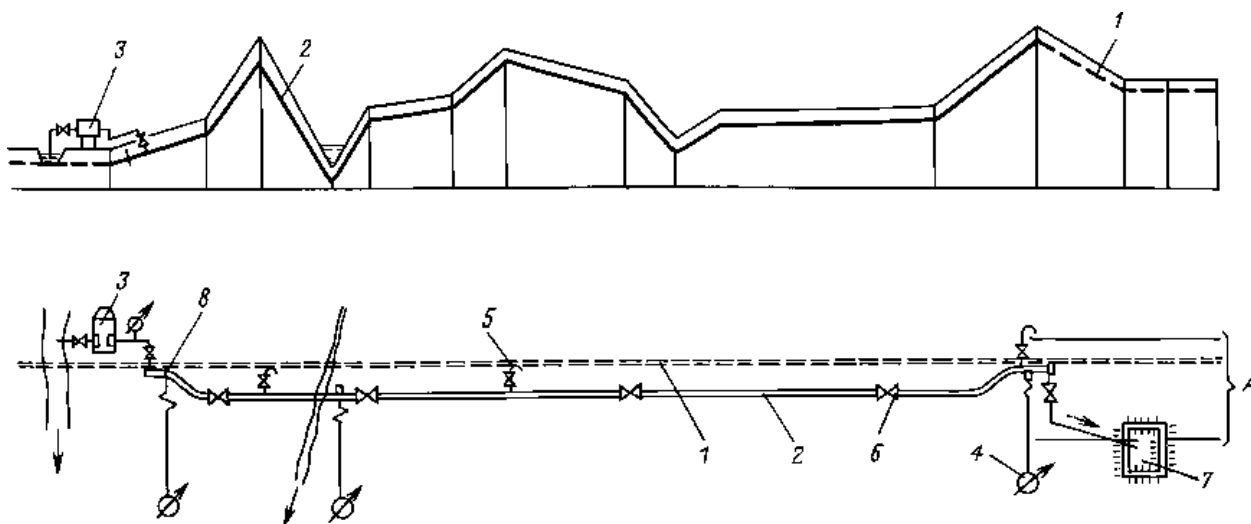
Схема гидравлического испытания участка нефтепровода:
